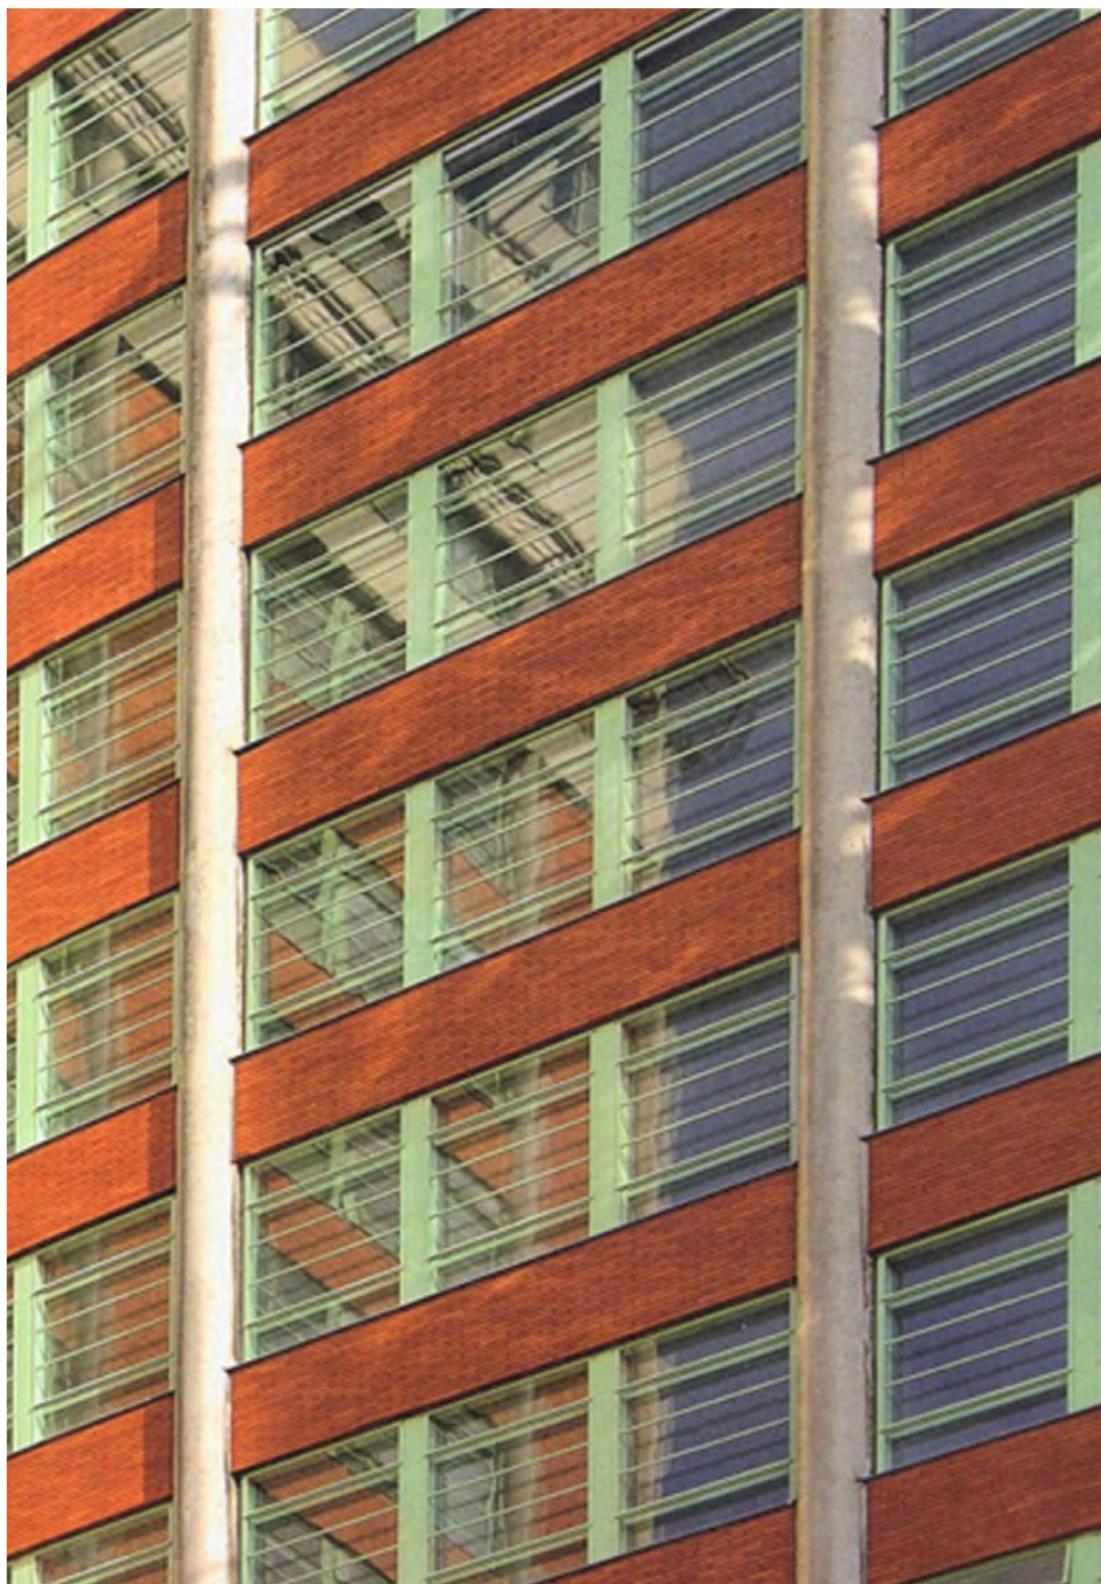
Visión actual de revestimientos exteriores tras rehabilitación: ladrillo y vidrio alternando con estructura de hormigón vista.
